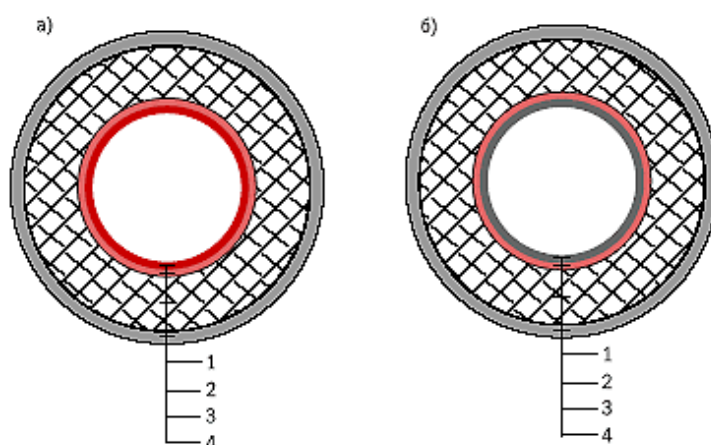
Конструкция теплопроводов в армопенобетонной изоляции:
